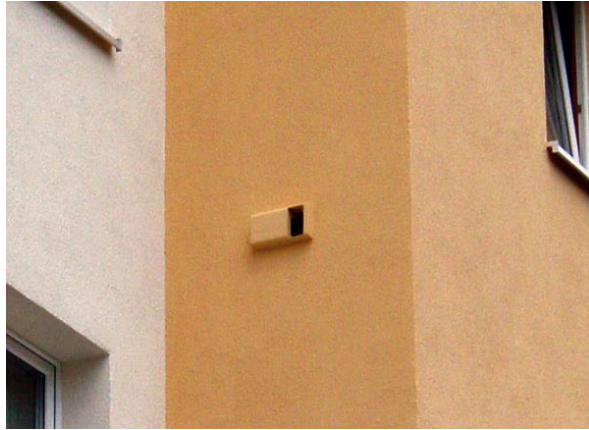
Fassaden-Einbaukasten 1HE, Einbaubeispiel Fassade (Quelle: www.schwegler-natur.de)
